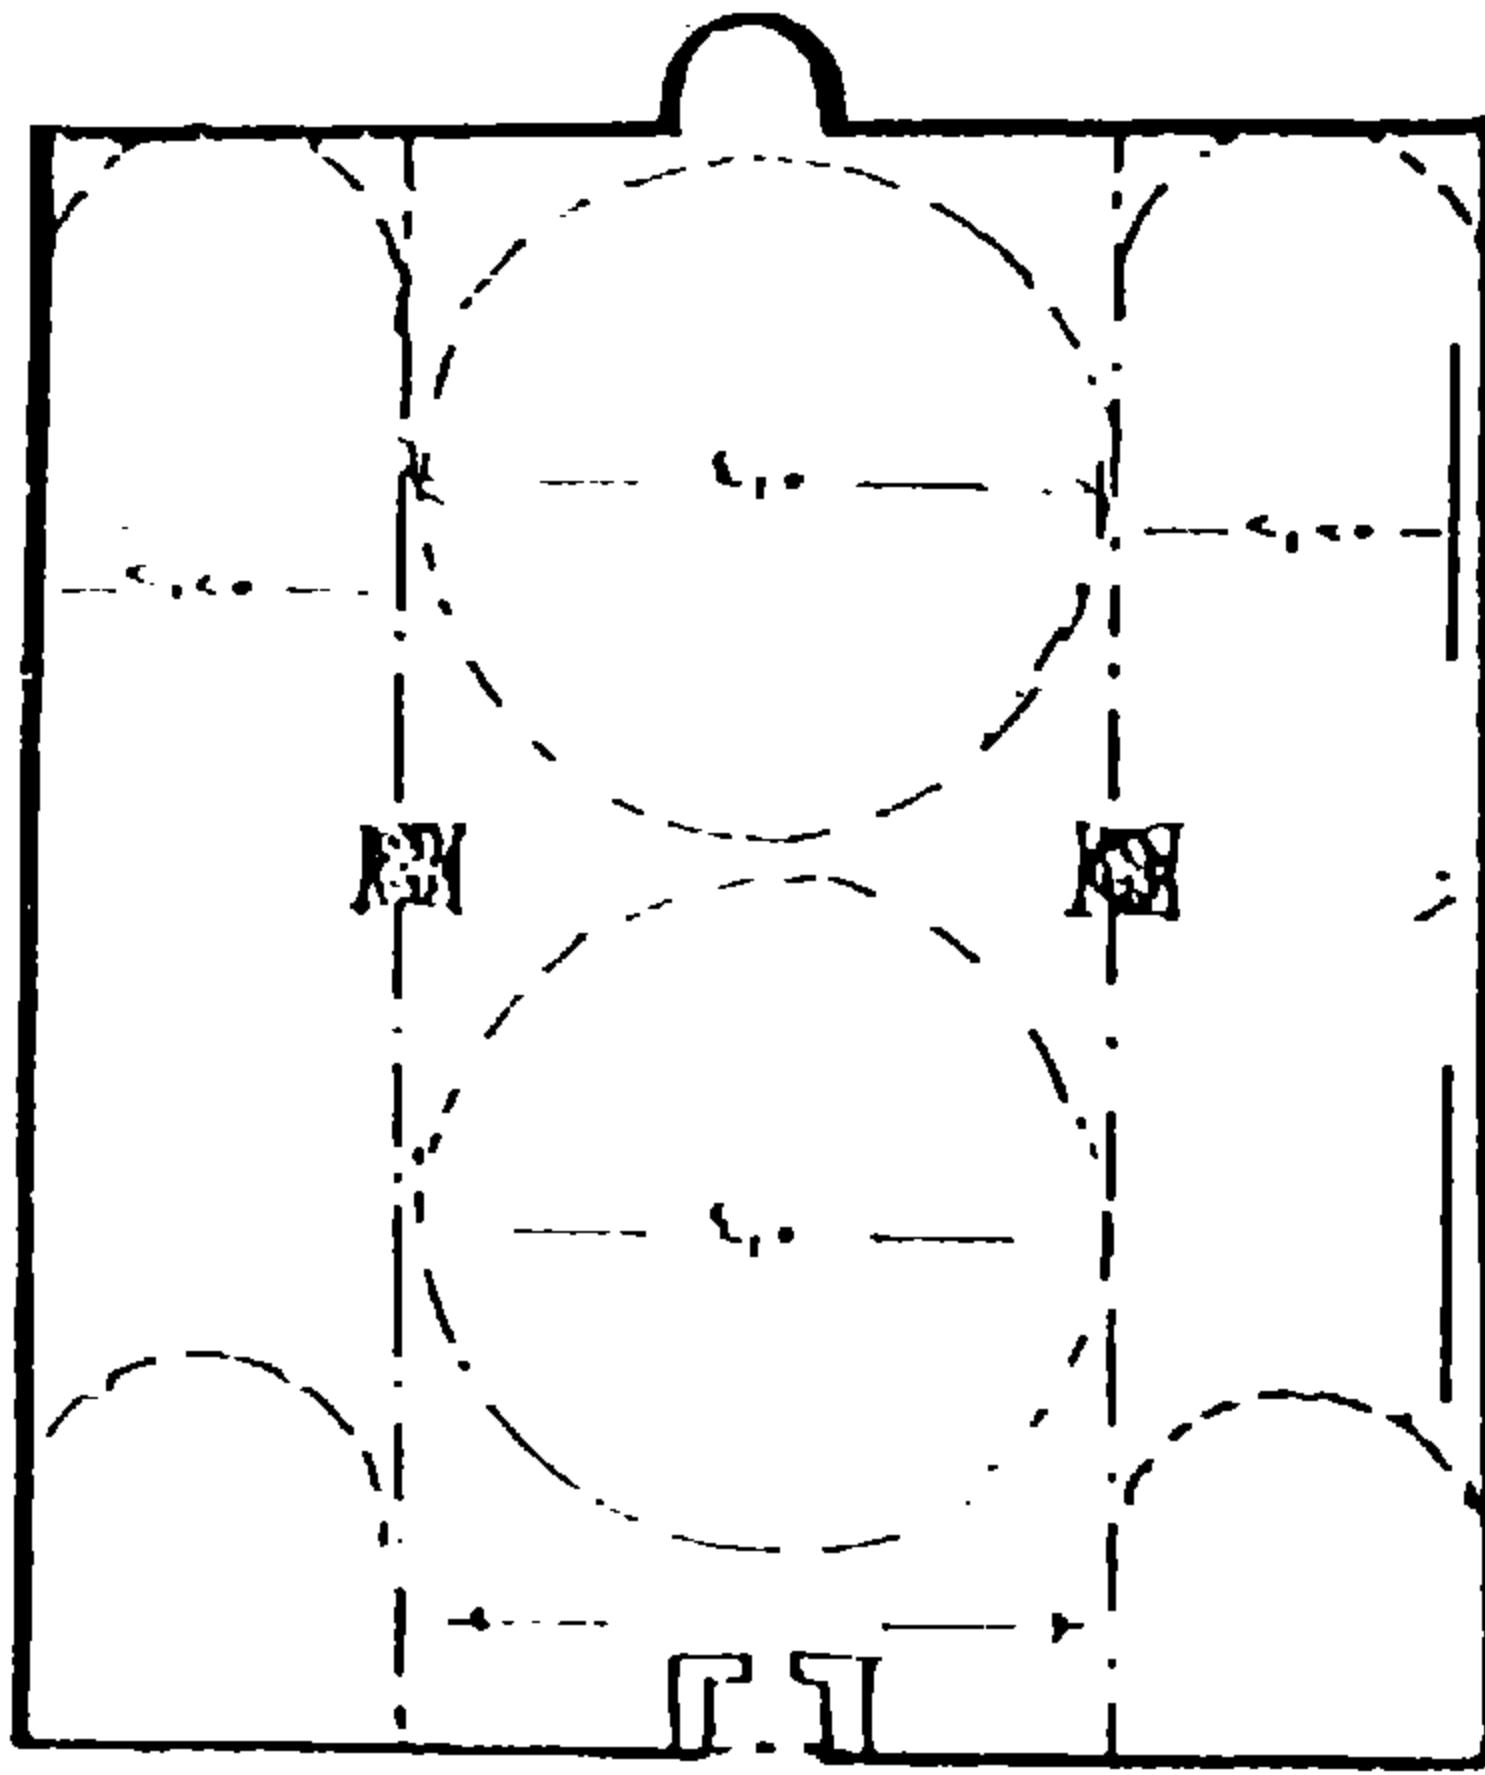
المسقط الأفقي لمشهد آل طباطبا
